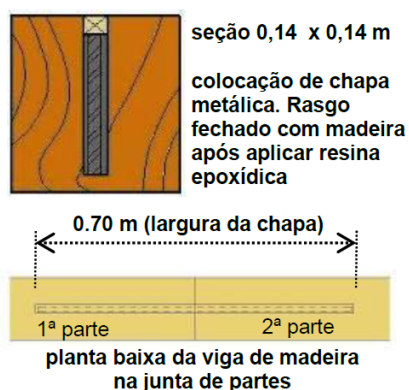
Consolidação de vigas (Muñoz; Muraro, 2013, p.19)
